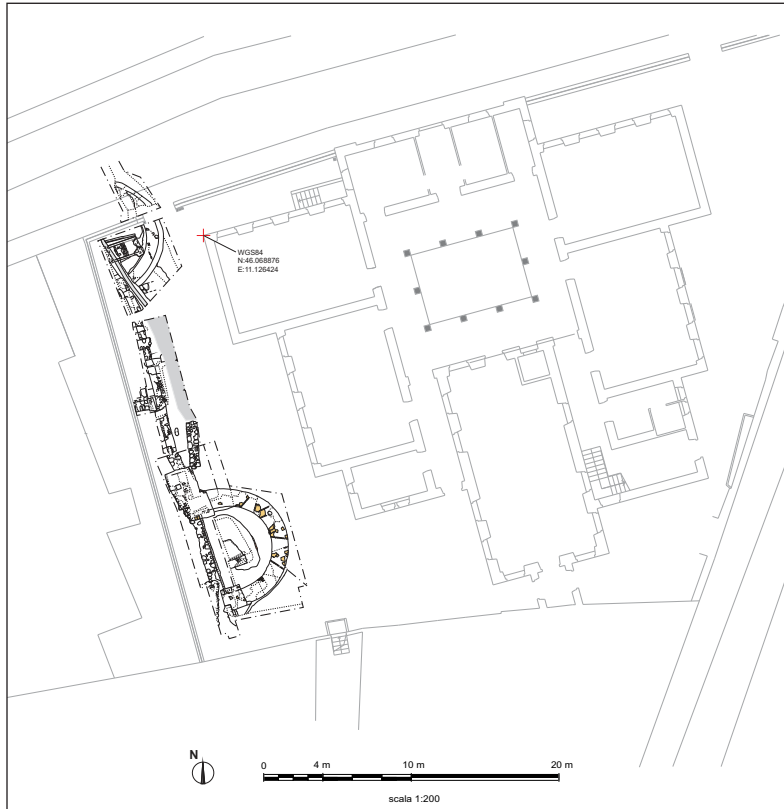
Trento, via F. Ferruccio, p.ed. 2098. Planimetria generale dei resti emersi.
